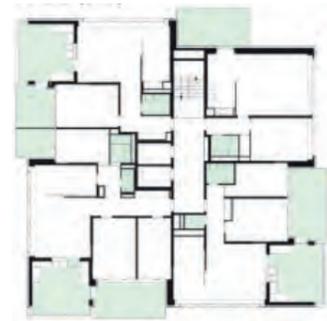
Grundriss Regelgeschoss neu
